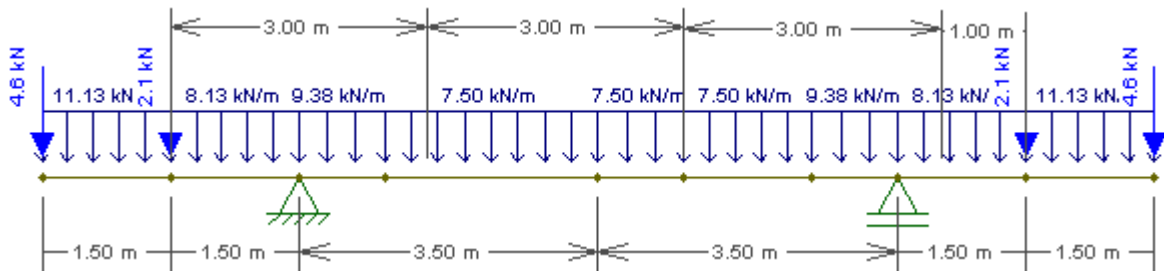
27 – Aplicação das cargas permanentes, em perfil transversal
